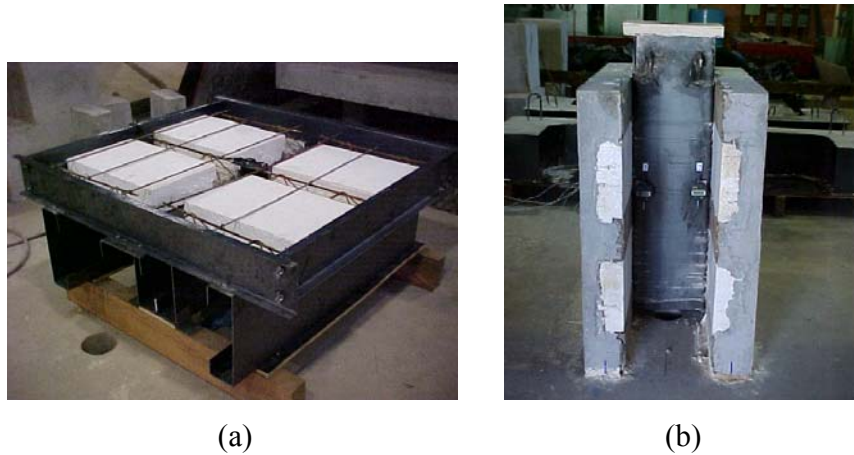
Foto com detalhe da armadura da laje nervurada (a) e de um modelo de cisalhamento direto após a concretagem das lajes (b) (DAVID, 2003).
